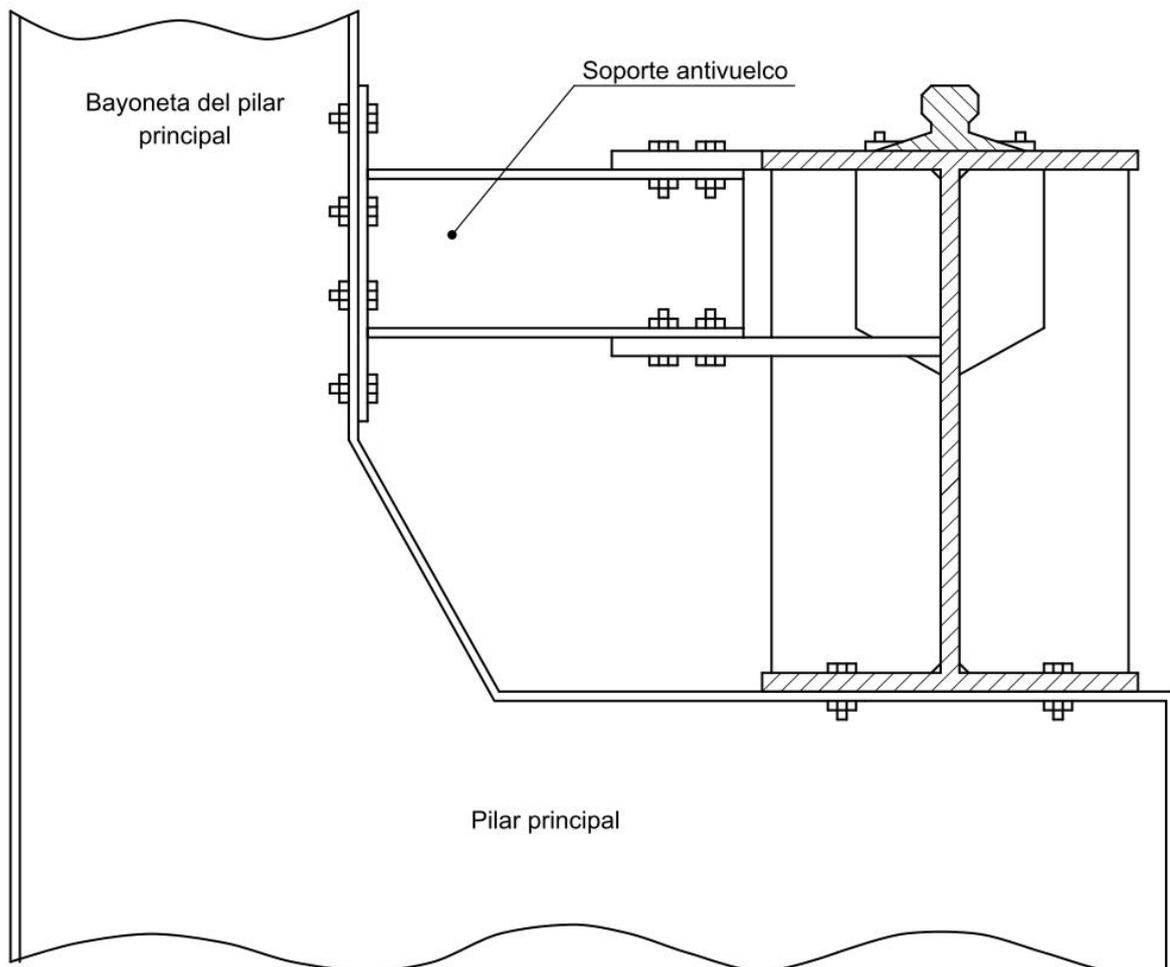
Esquema de montaje de los soportes antivuelco de las vigas carril.
